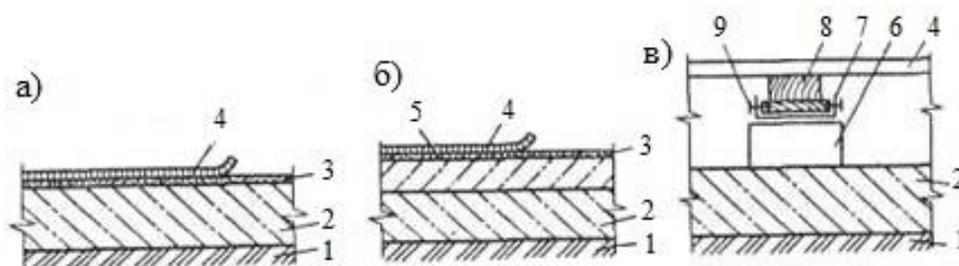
Виды полов по грунту: а) бетонная подготовка; б) утепленное половое покрытие; в) вид по лагам на столбиках; 1 - уплотненный грунт; 2 - бетонная подготовка; 3 - стяжка; 4 - покрытие пола; 5- утепляющий слой; 6 - кирпич; 7 - два слоя рубероида; 8- лага; 9 - антисептированная подкладка
